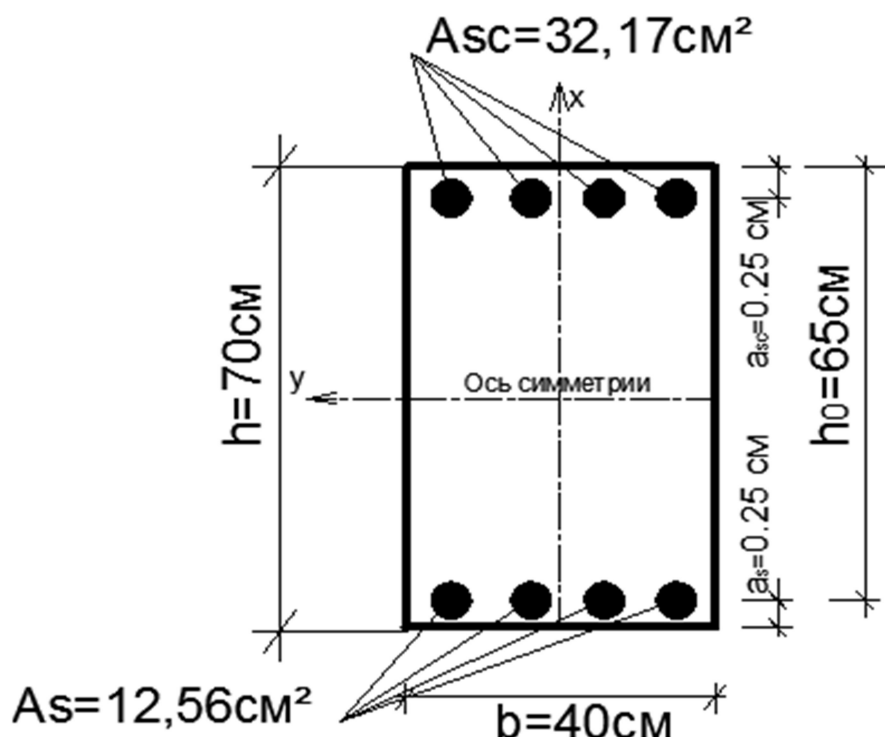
Поперечное сечение железобетонной колонны и ее армирование
